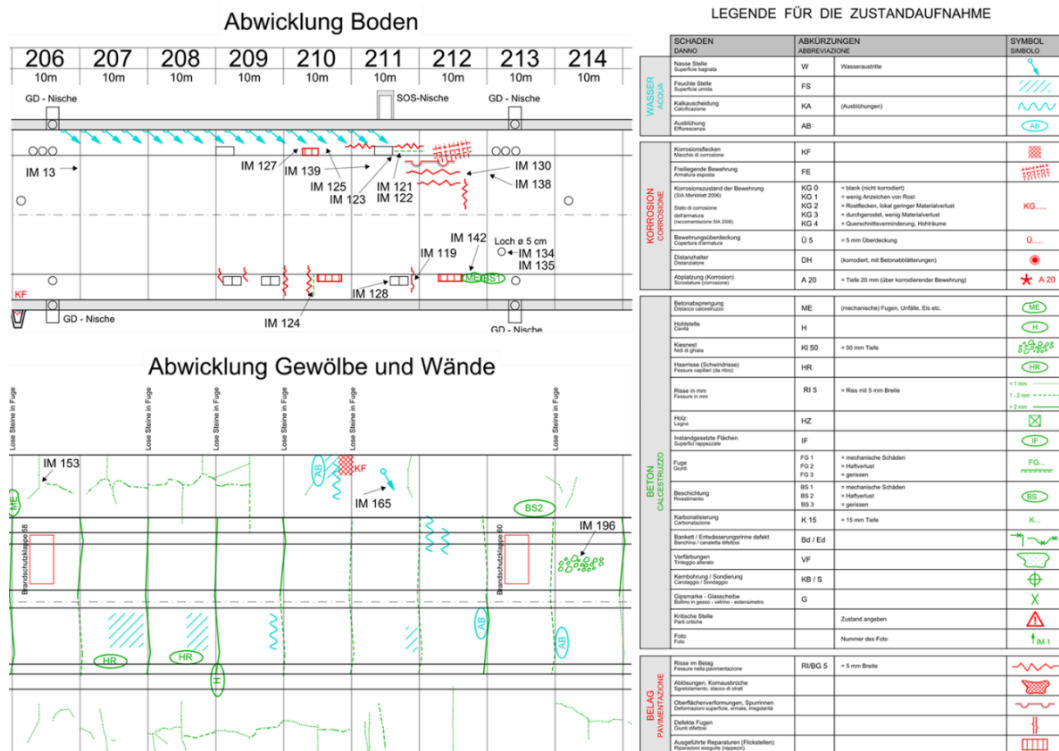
Befundaufnahme Hauptinspektion 2015 N28 Tunnel Gotschna (Ausschnitt Schadenplan)
